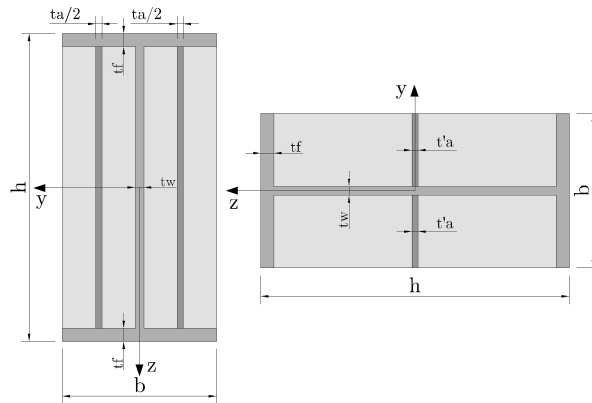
Distribuição da armadura para cálculo da esbelteza da coluna mista, segundo o eixo y e z .
